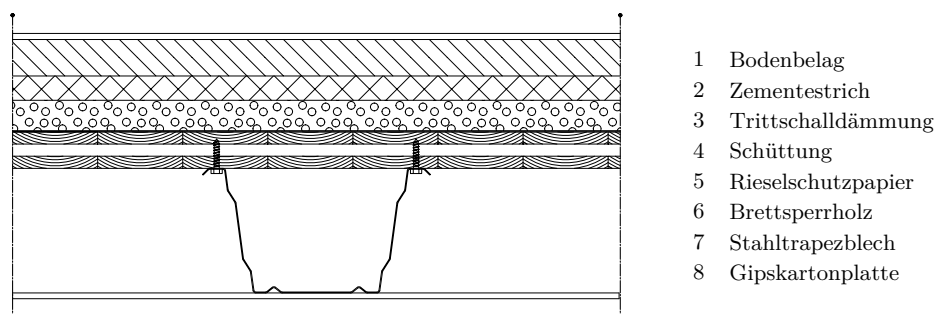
Möglicher Deckenaufbau der Stahl-Holz-Verbunddecke
